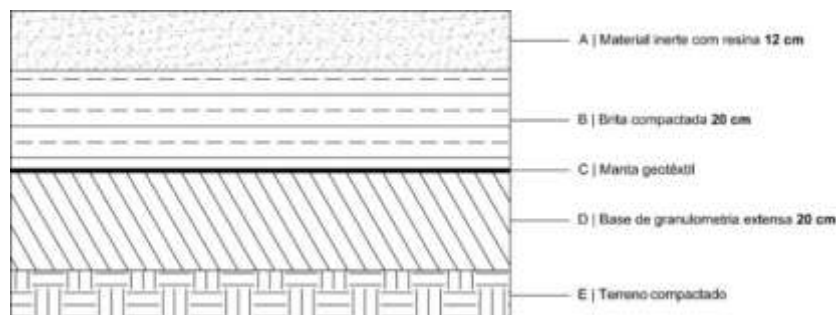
Perfil transversal tipo – pavimento em gravilhas agregadas com ligantes
